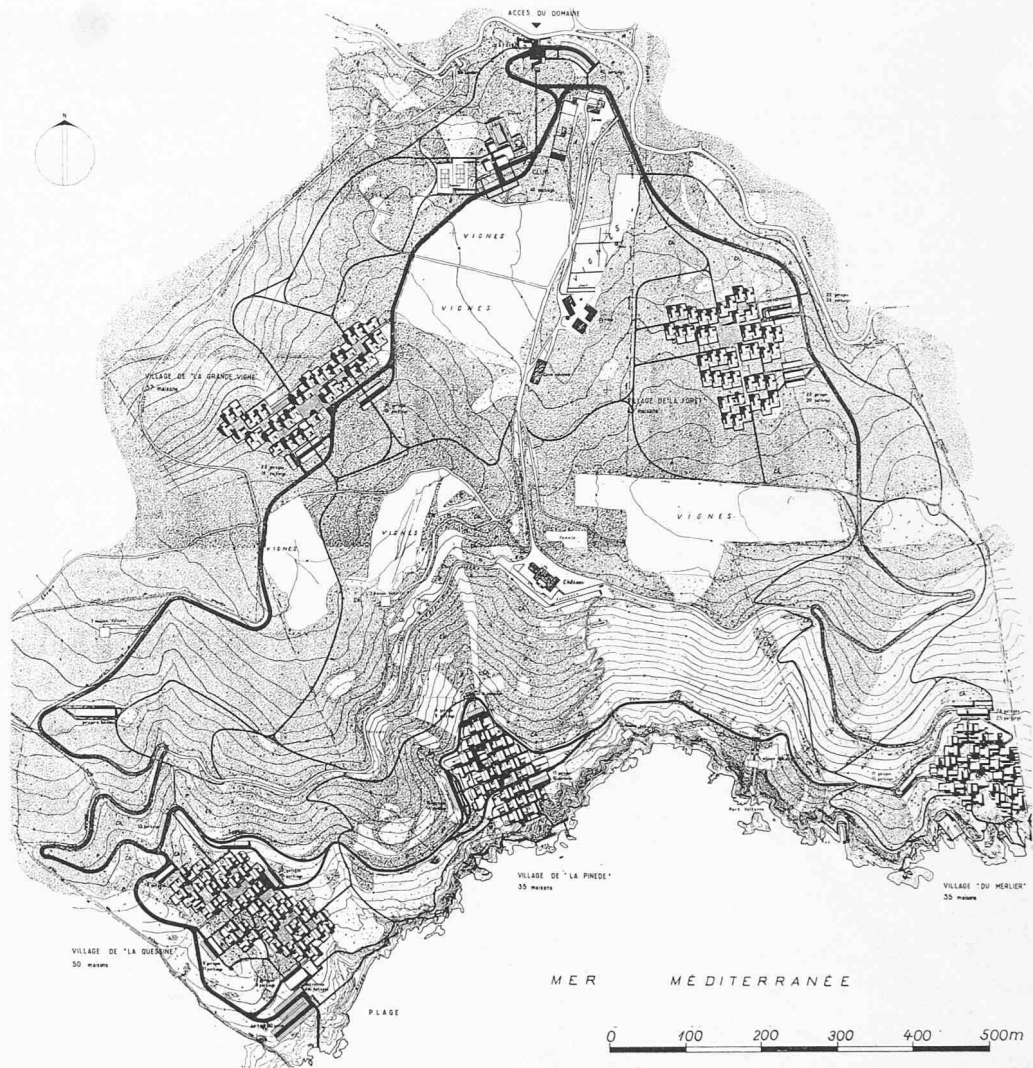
Situationsplan 1:10 000 Château Volterra. Die erste Baue-tappe Village «Du Merlier» unten rechts. Architekten: L. Arretche, J. Renaudie, P. Riboulet, G. Thurnauer, J.-L. Véret, Klubhaus, Restaurant, Einkaufsläden am Eingang der Domäne (oben)
